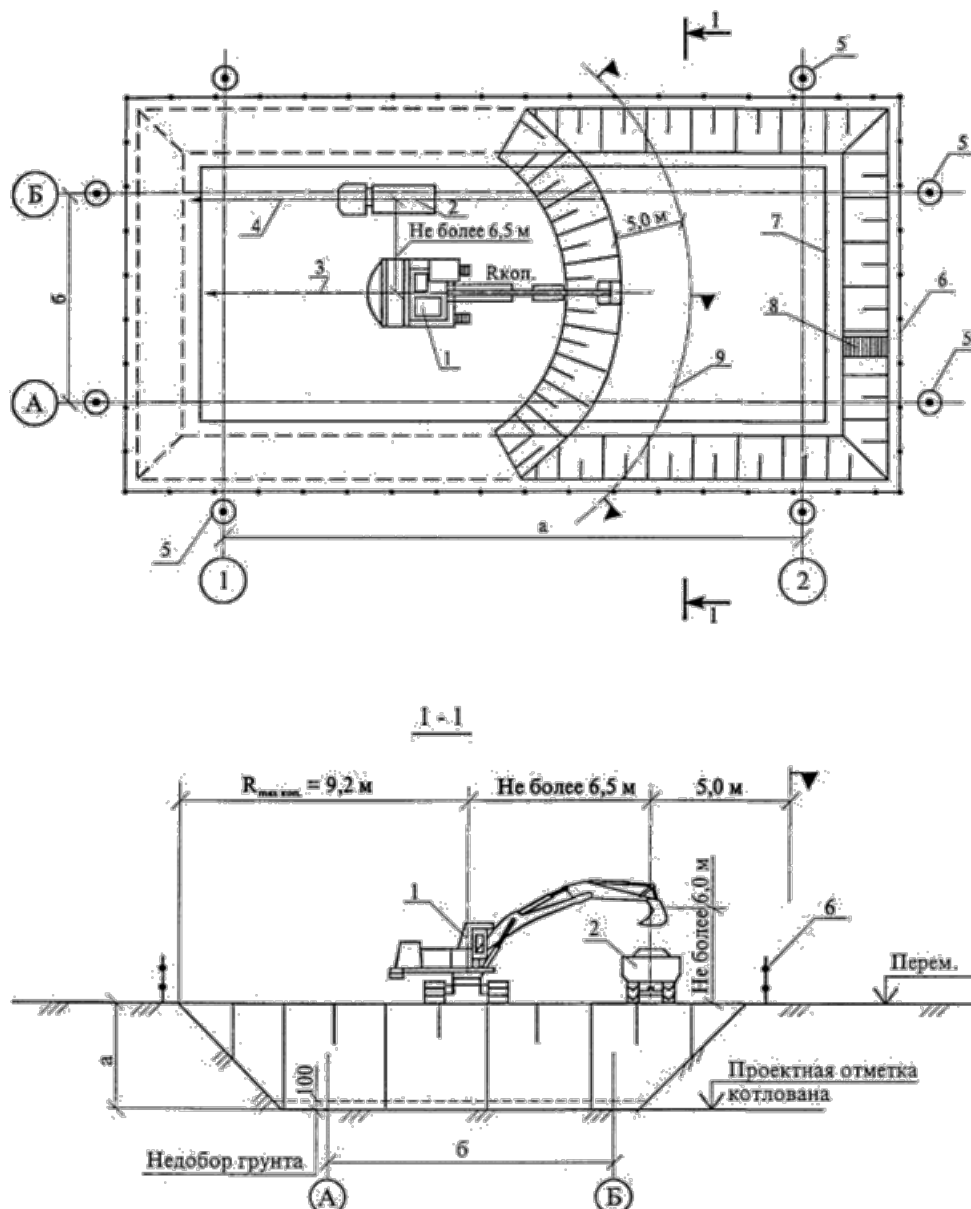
Схема разработки грунта котлована экскаватором при лобовой проходке
